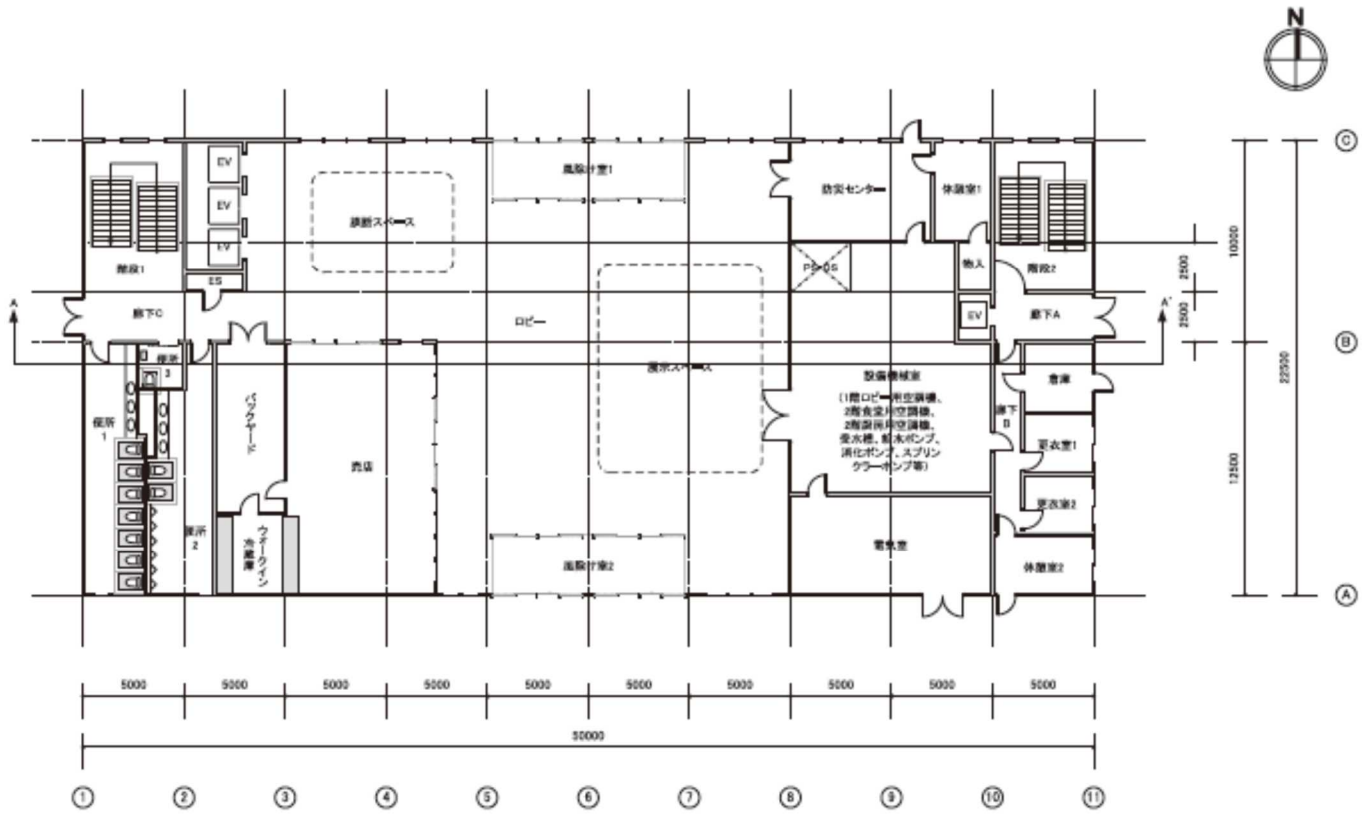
モデル建物（大学等、高層棟） 1階平面図
